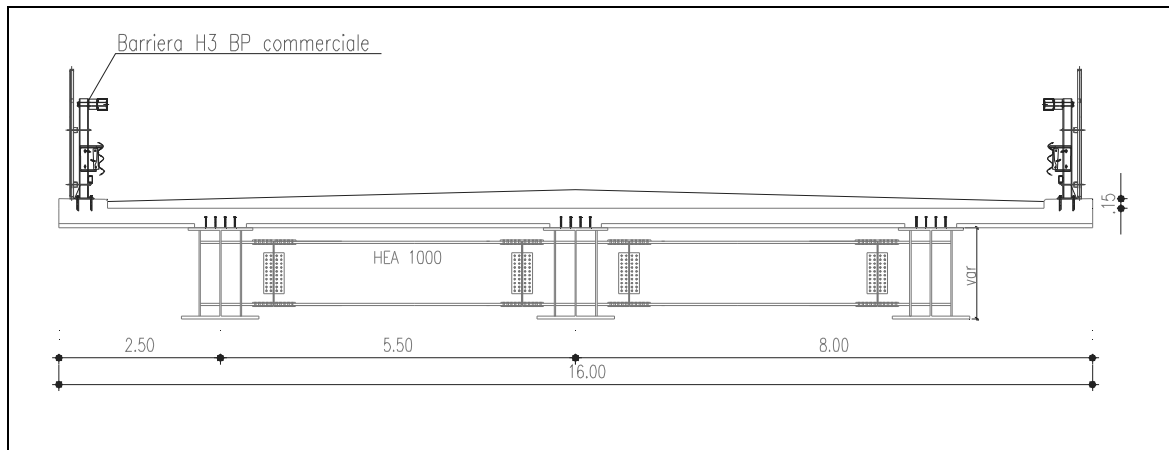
Sezione trasversale corrente con trasverso di spalla
